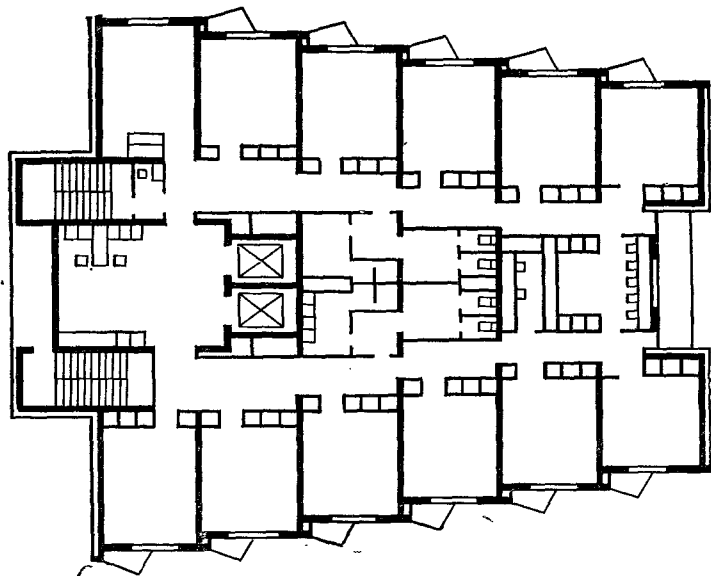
План типового этажа общежития студентов, построенного в крупнощитовой опалубке в Вильнюсе
